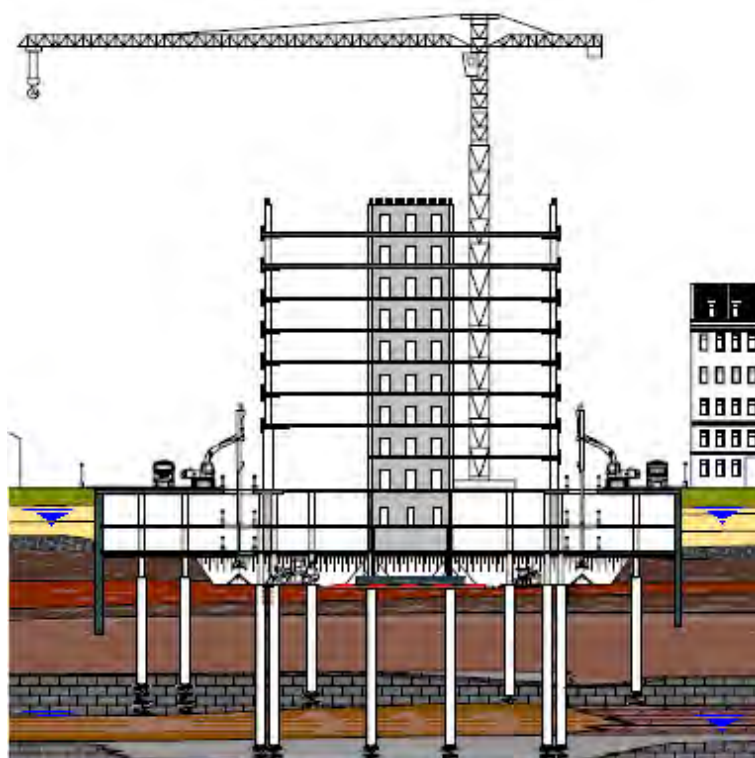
Возведение 9-го надземного этажа параллельно с устройством фундаментной плиты на 3-м подземном этаже административного здания «Дукат Плейс III»
